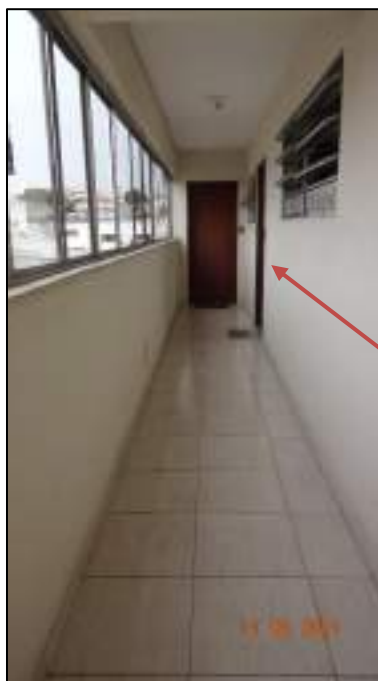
Vista do hall dos elevadores do 3º andar do pavimento tipo do Edifício "Veneza".
